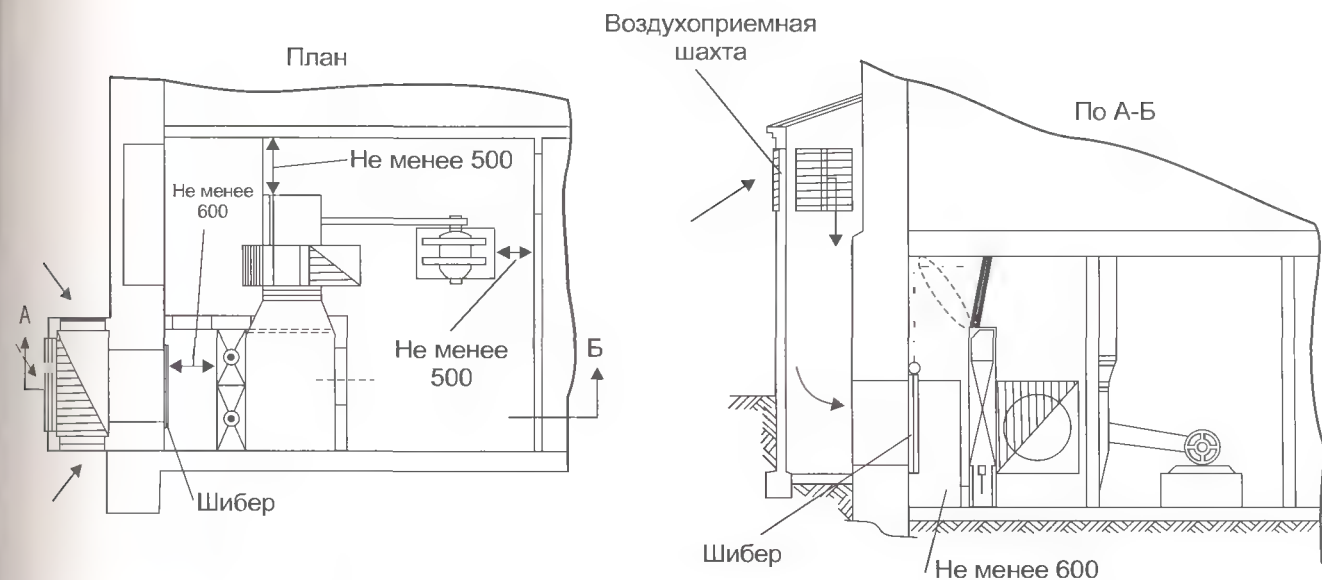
Компонировка приточной камеры, расположенной в подвале здания [27]
